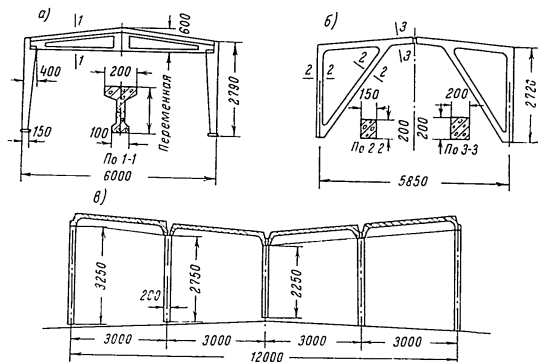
Сборные конструкции фонарных стропил одноэтажных промышленных зданий
